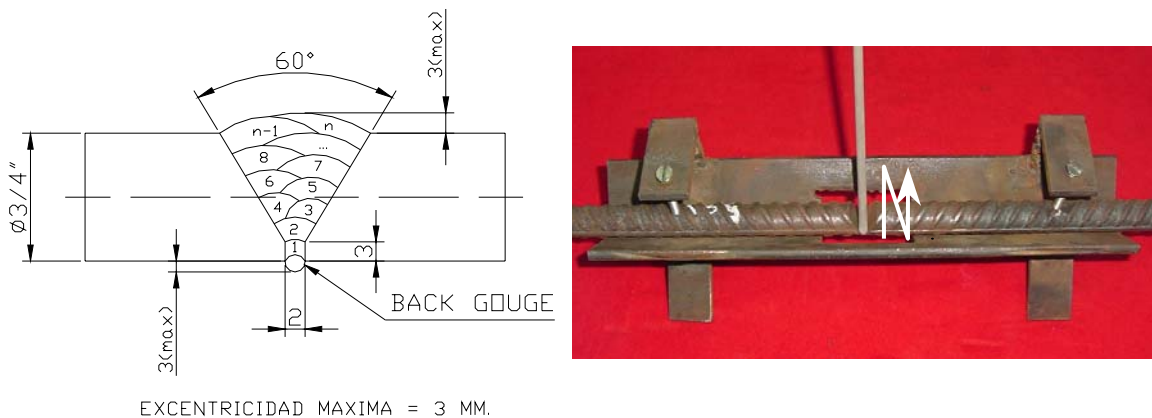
Detalle geométrico y técnica de soldeo para la posición 1G
